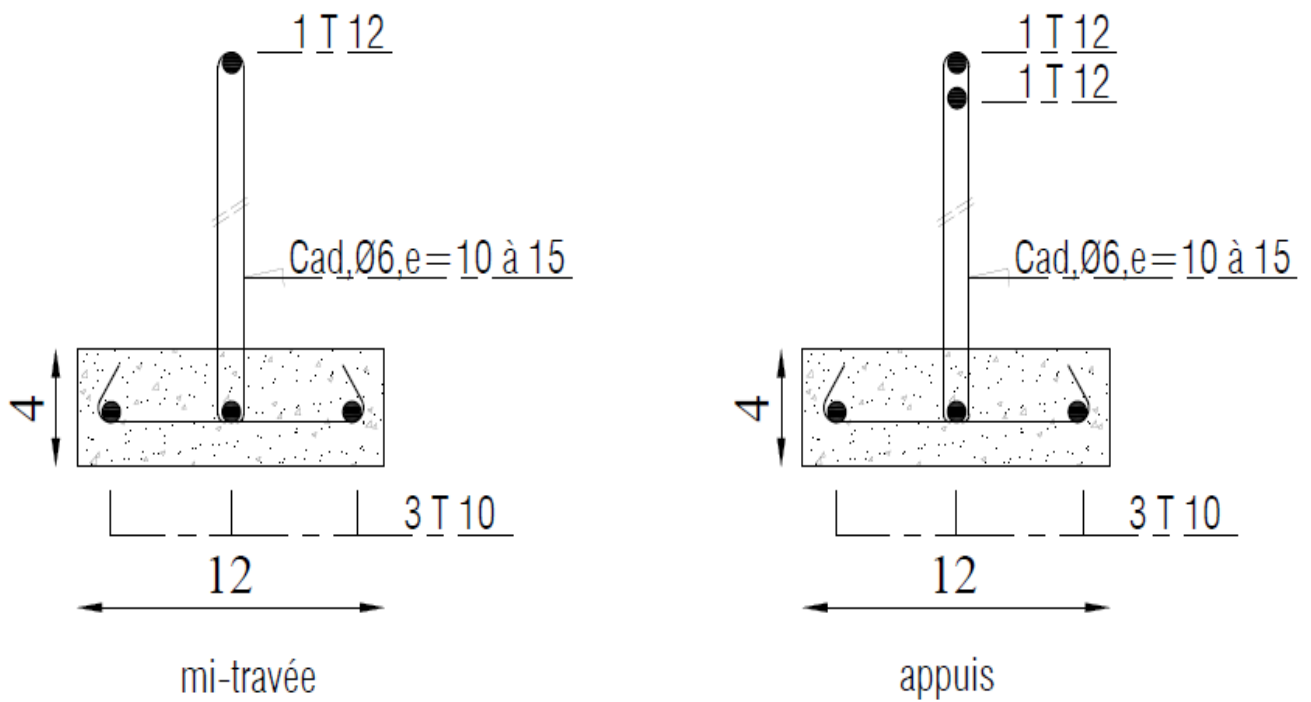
ferrailage des poutrelles en travée, et en appuis
